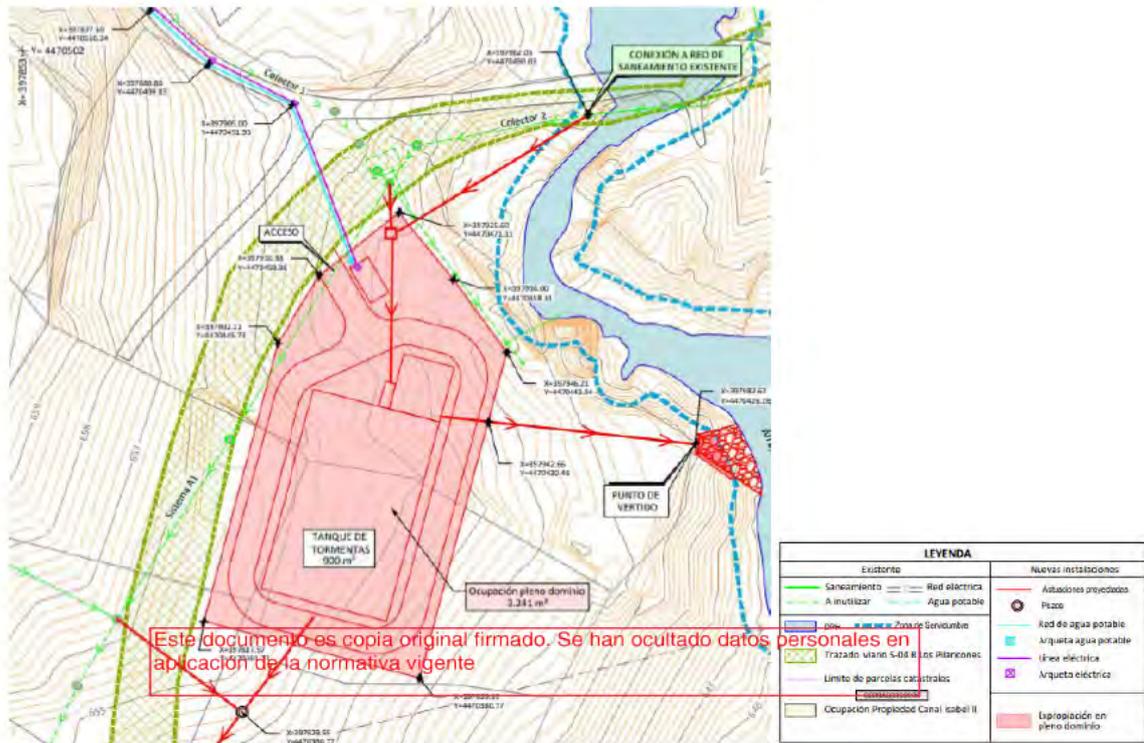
Plano en planta del aliviadero. Fuente: Elaboración propia.
